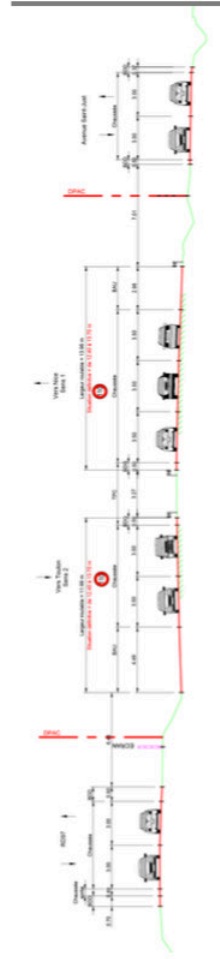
Profil en travers de l'A57 entre La Bigue et Pierre Ronde
